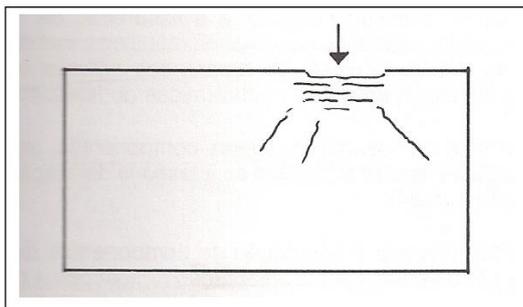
Fissuras provocadas por cargas concentradas.
